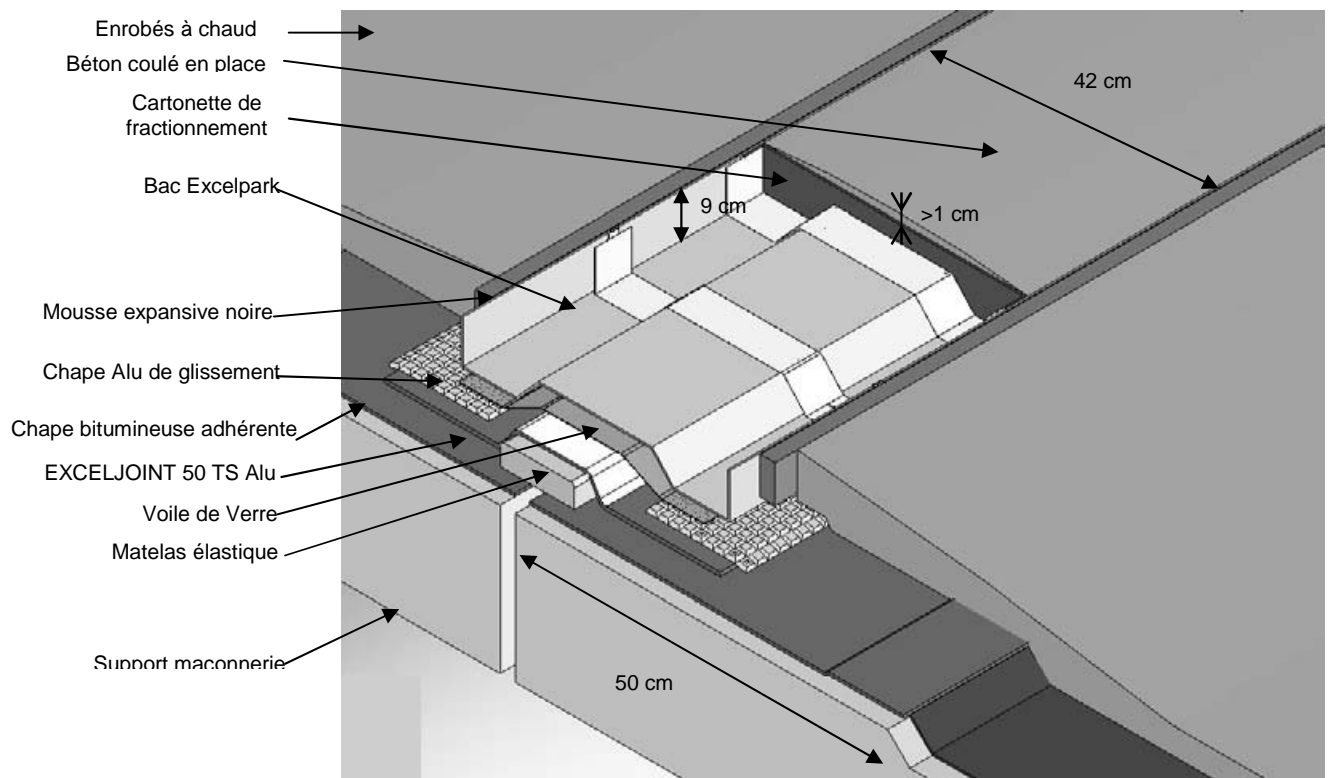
EXCELPARK 1 Béton avec protection par béton bitumineux : Schéma de principe sur support maçonnerie
